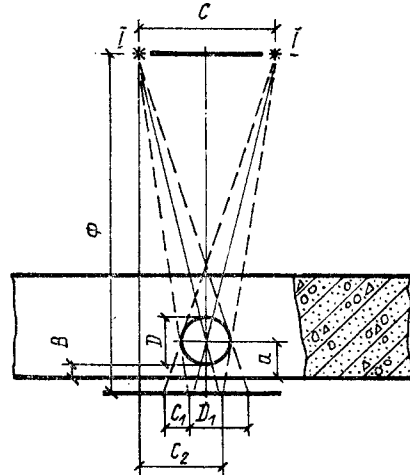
Схема просвечивания железобетонной конструкции со смещением излучения
